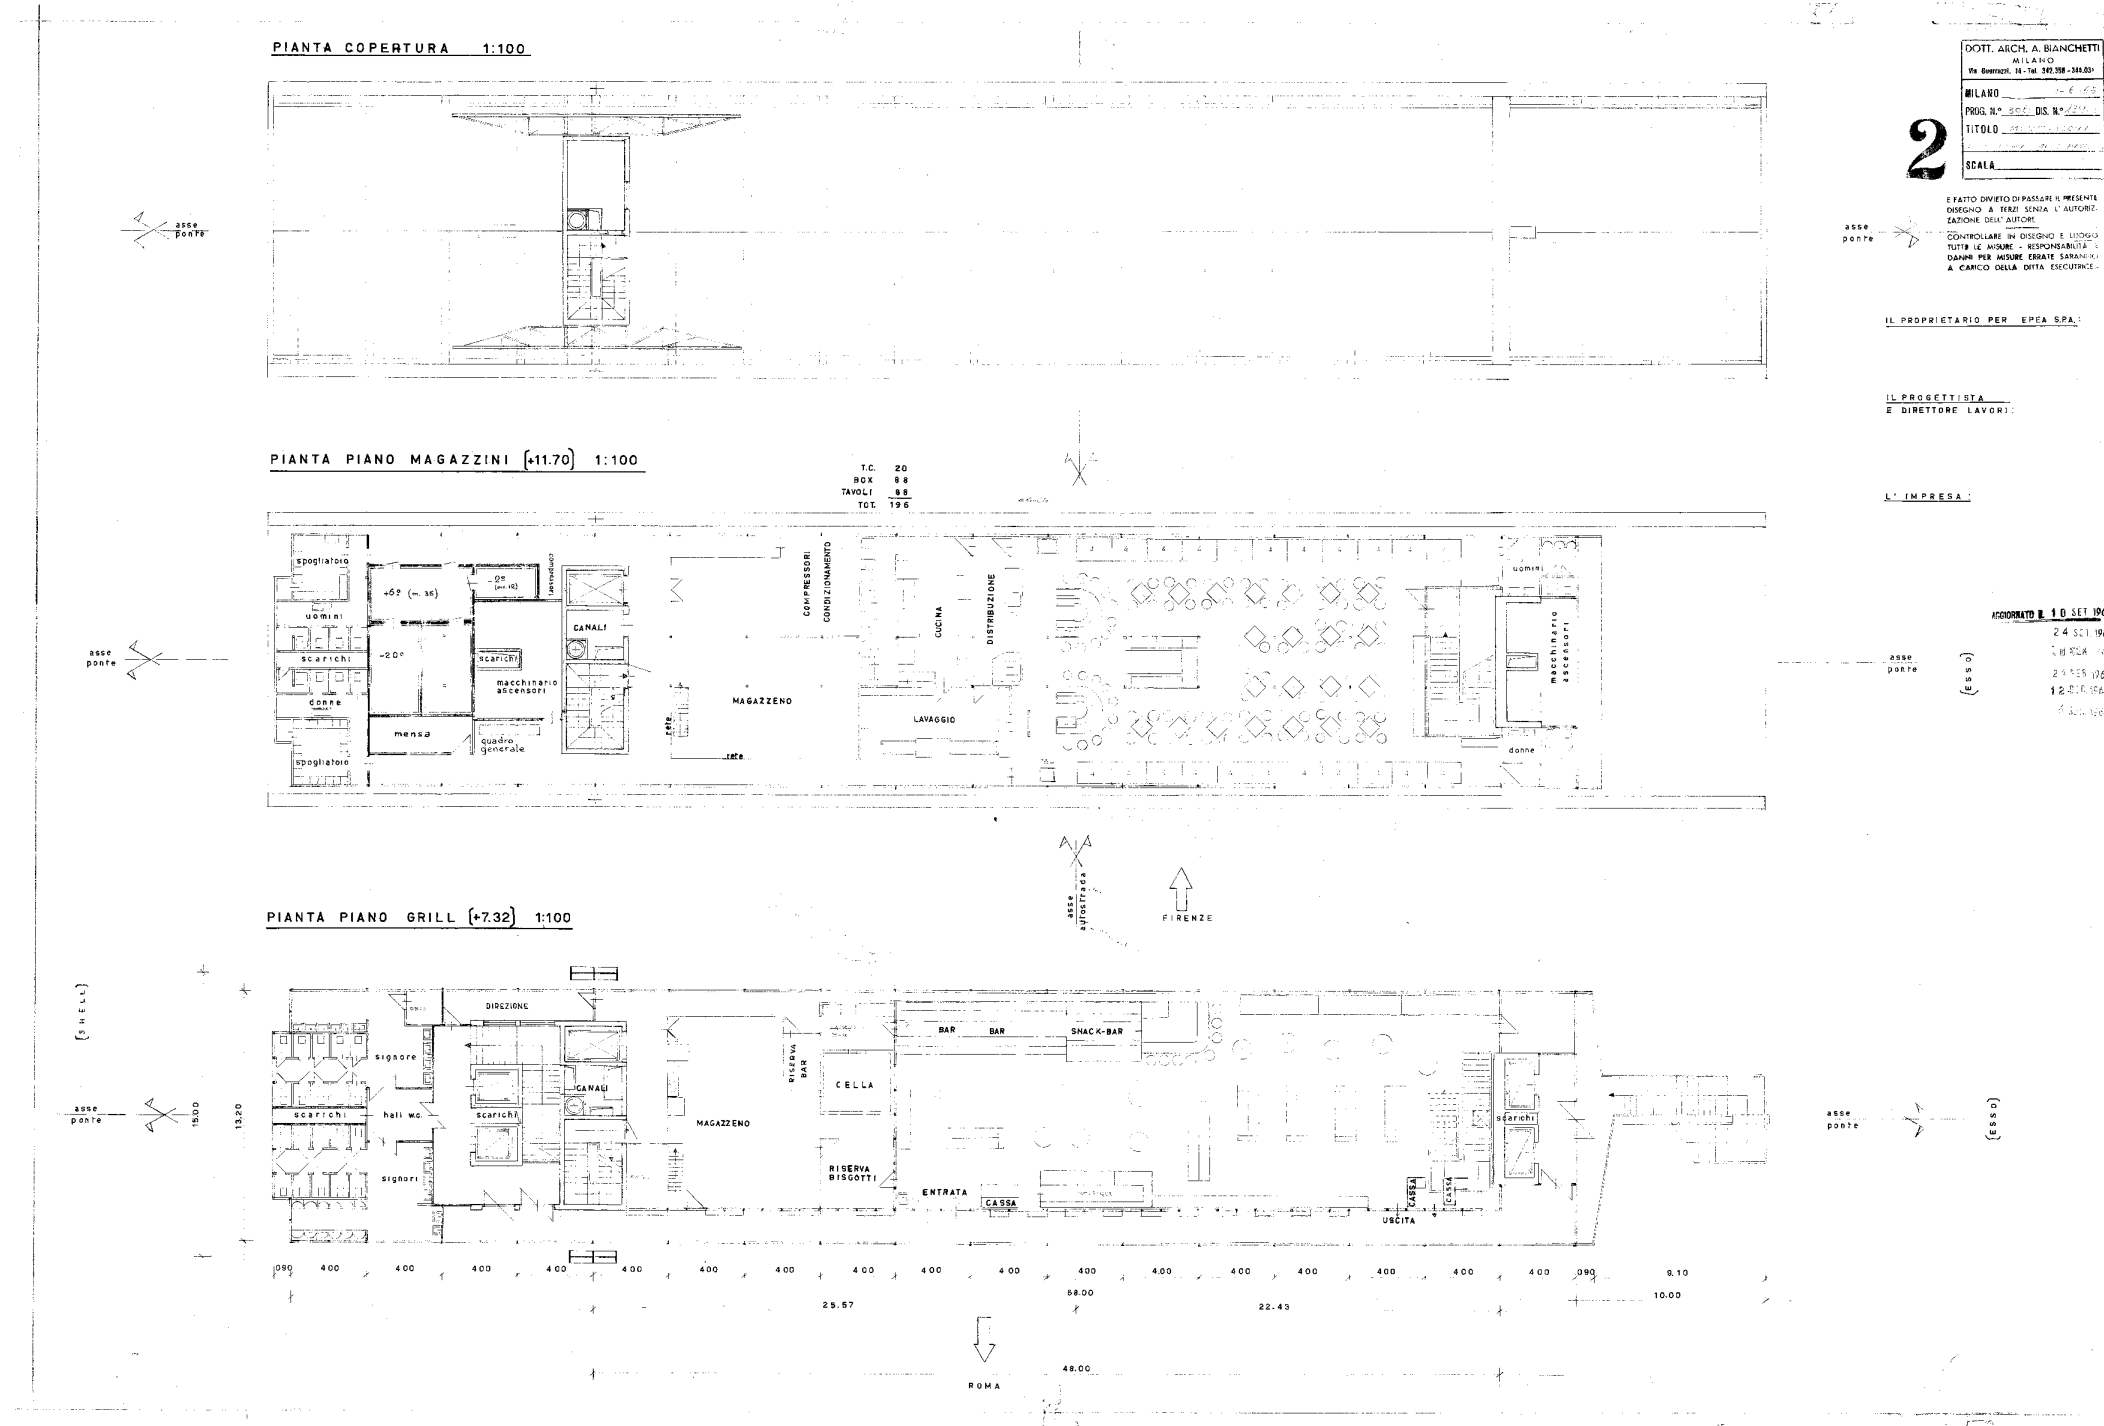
Pianta del primo piano ponte (in basso), del secondo piano piano ponte, della copertura (in alto), (AAB)
